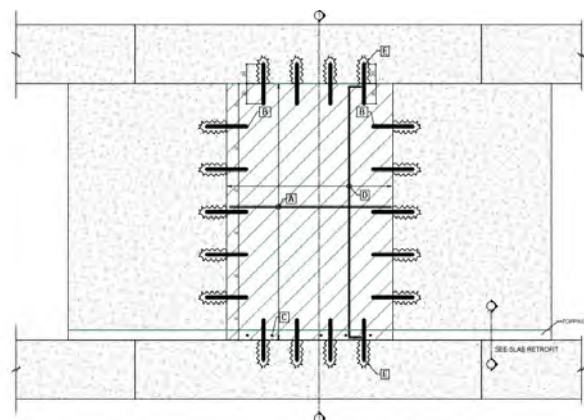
Unión piezas prefabricadas con hormigón armado y conexión con pasadores.
